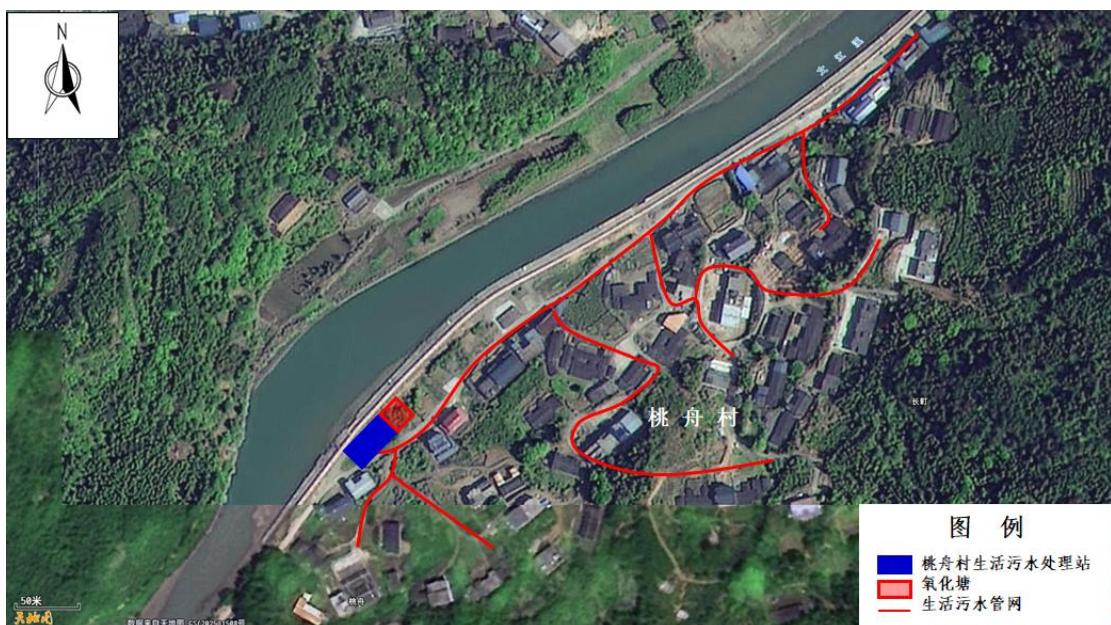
氧化塘工程及配套生活污水处理站平面布置图
